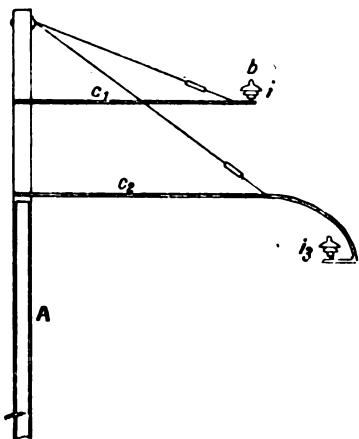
Poteaux Thomson-Houston pour portées de 100 m.
